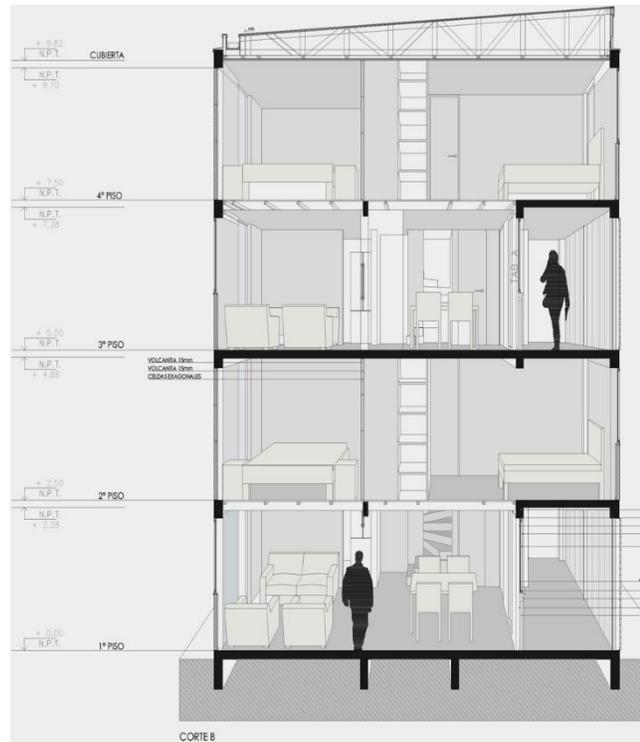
corte del edificio conjunto "las perdices" archdaily.com
